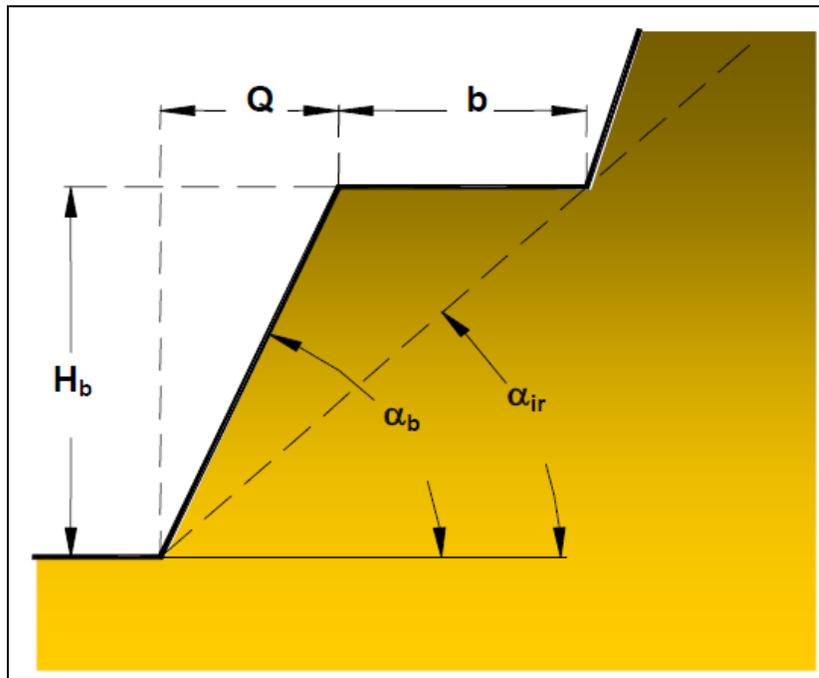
Parámetros que definen la geometría del sistema banco-berma.
